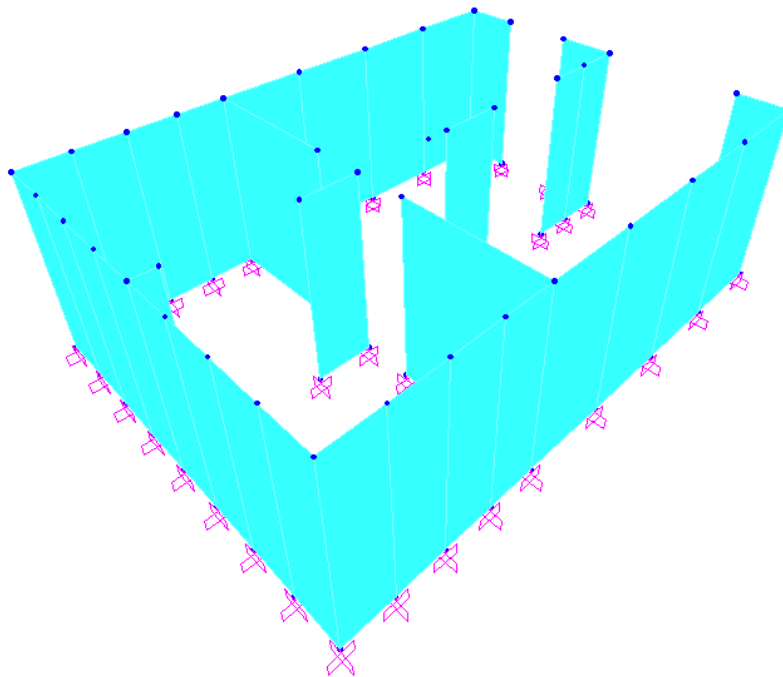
Vista 3d del modelo realizado en SAP2000 para la casa 2
